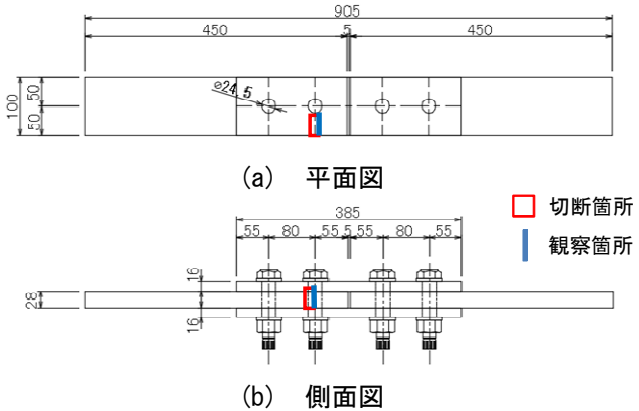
すべり試験体の形状・寸法と断面観察切断箇所と観察位置 (単位: mm)
